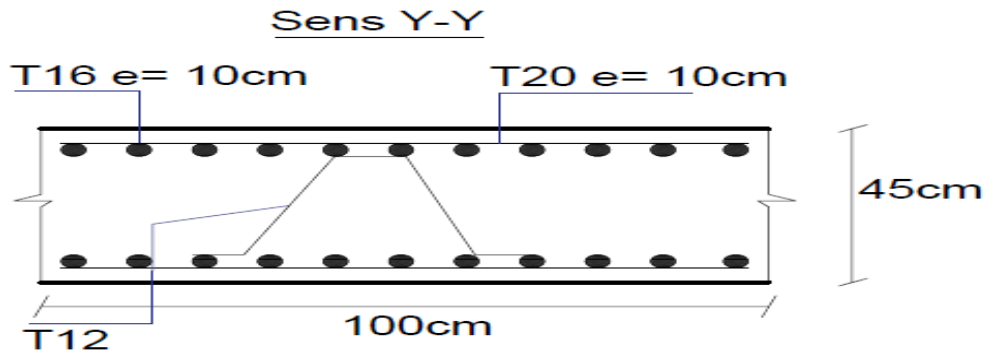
Schéma de ferrailage de la dalle du radier sens y-y.
